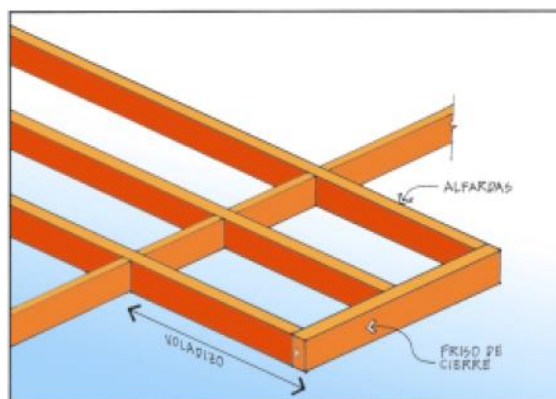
Detalle de entrepiso con vigas de madera acerrada.
